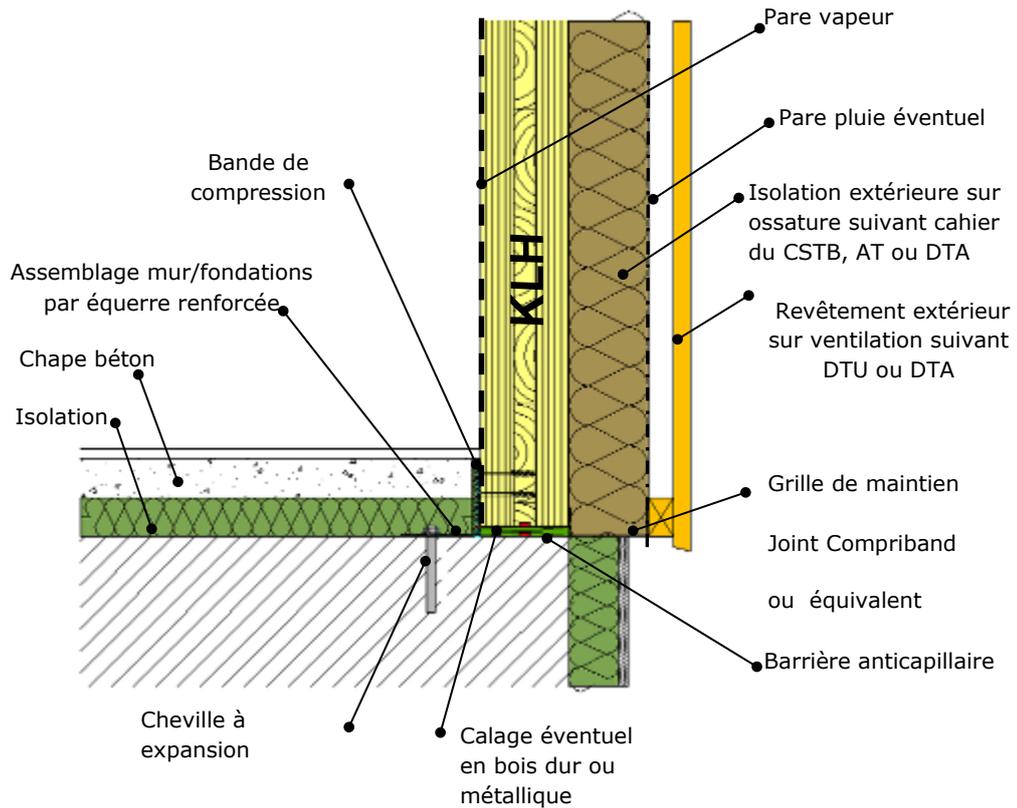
Coupe verticale mur extérieur/dalle béton avec bardage rapporté
